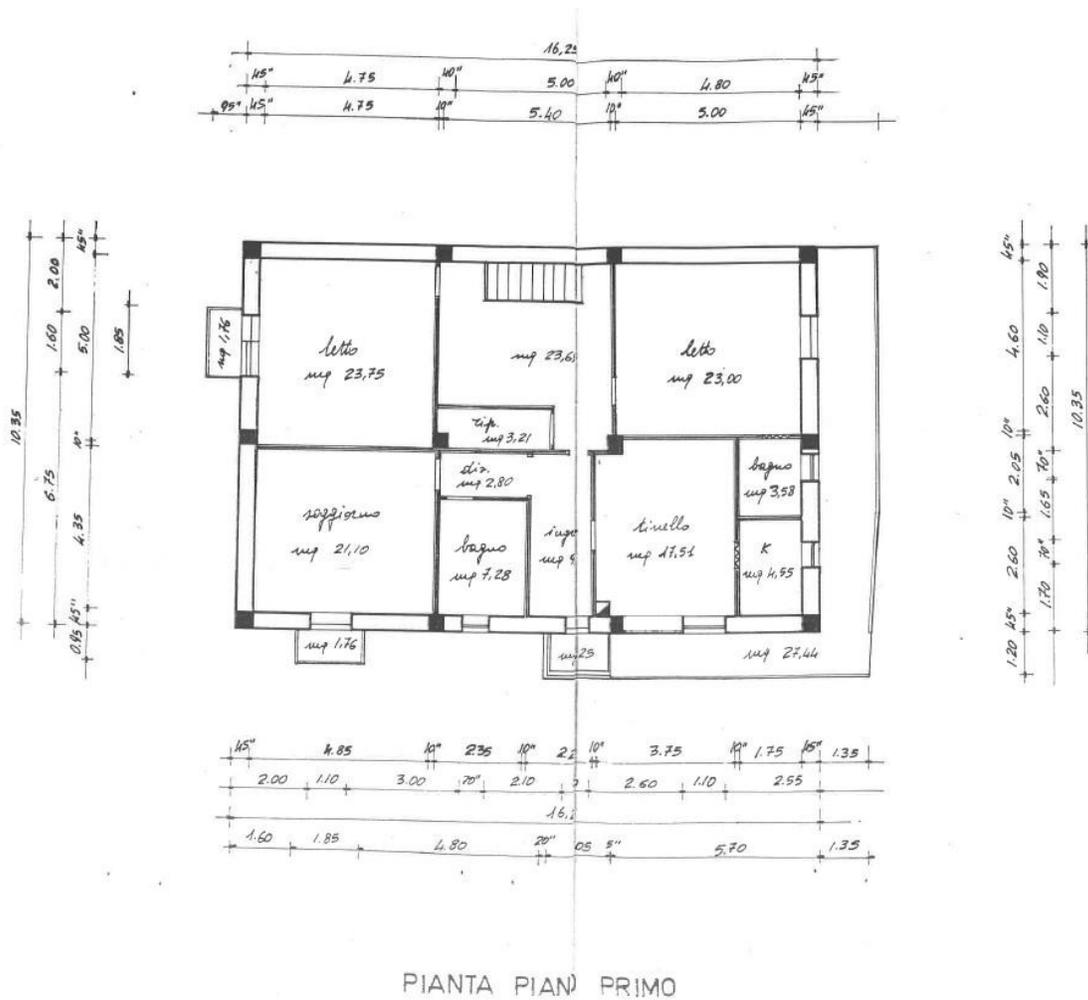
Pianta Piano 1° allegata alla Concessione Edilizia Prot. n. 7218 del 17.9.1987 Pratica n. 149
